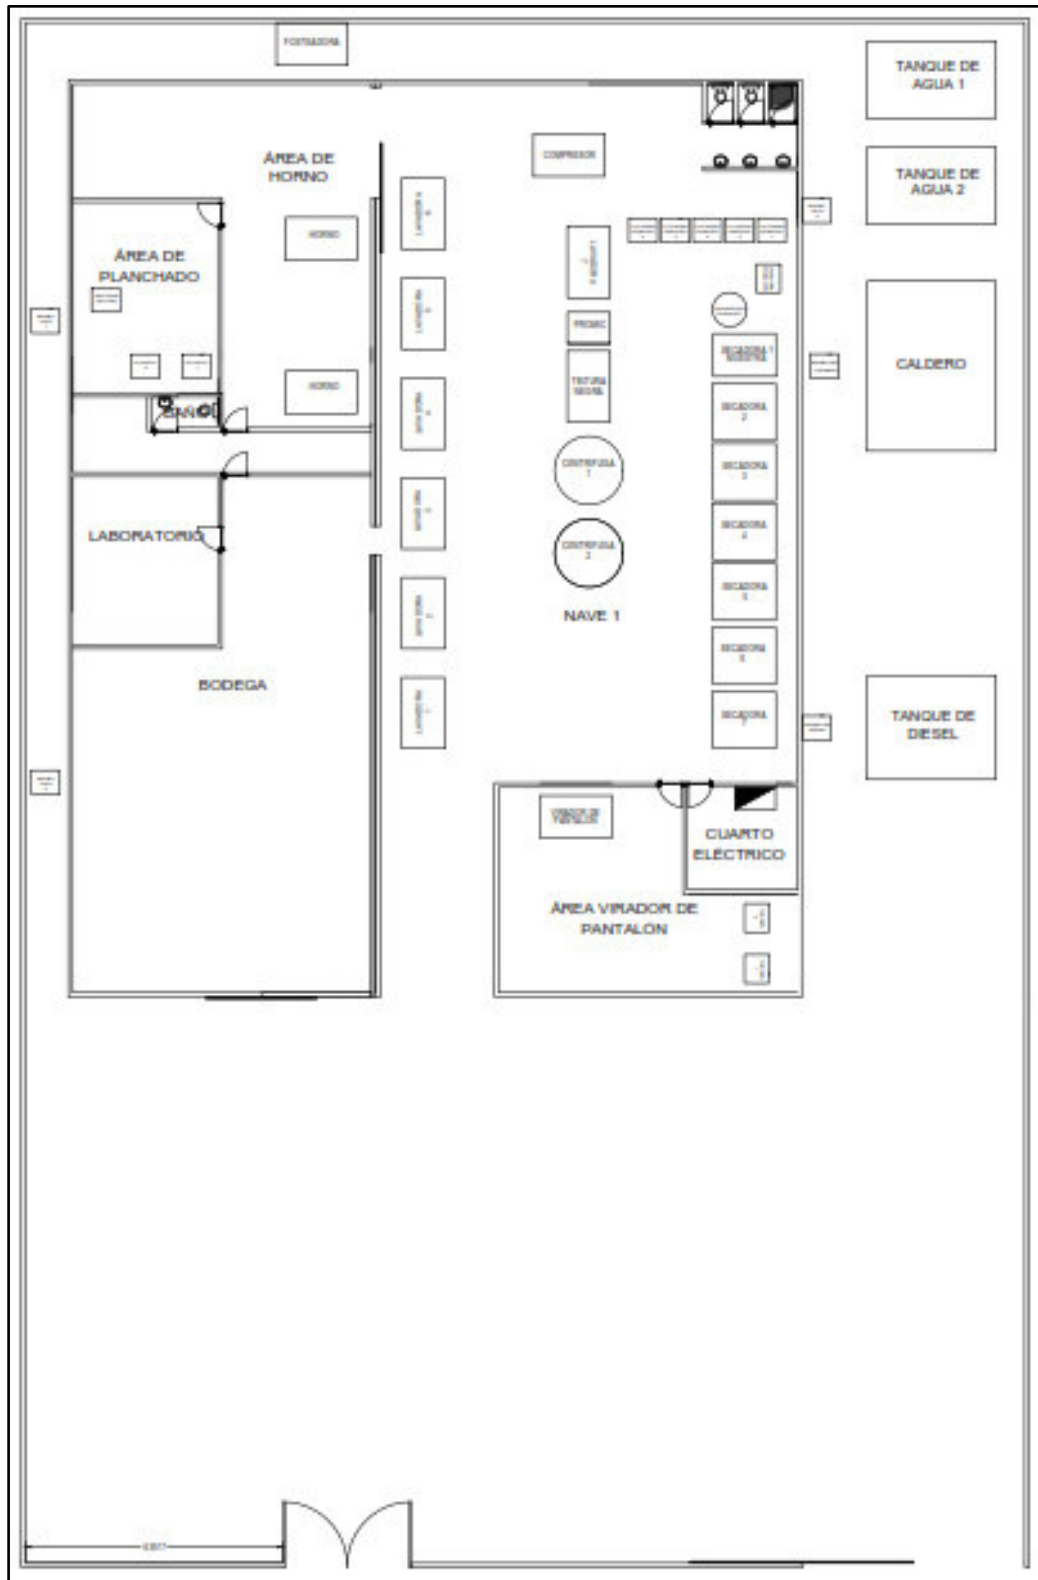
Vista del plano de la nueva planta "PROCONTEX". ANEXO B.2.
